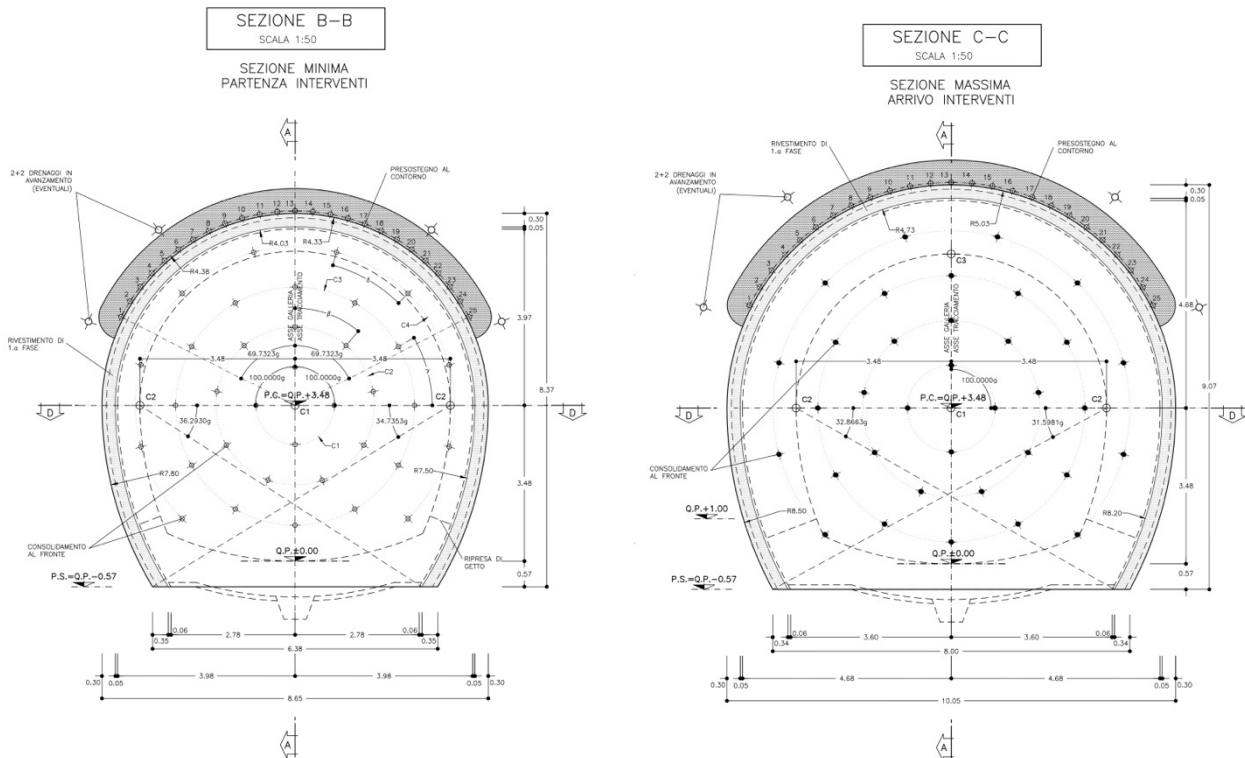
Sezione Tipo B2VP – Scavi e consolidamenti - Sezione
